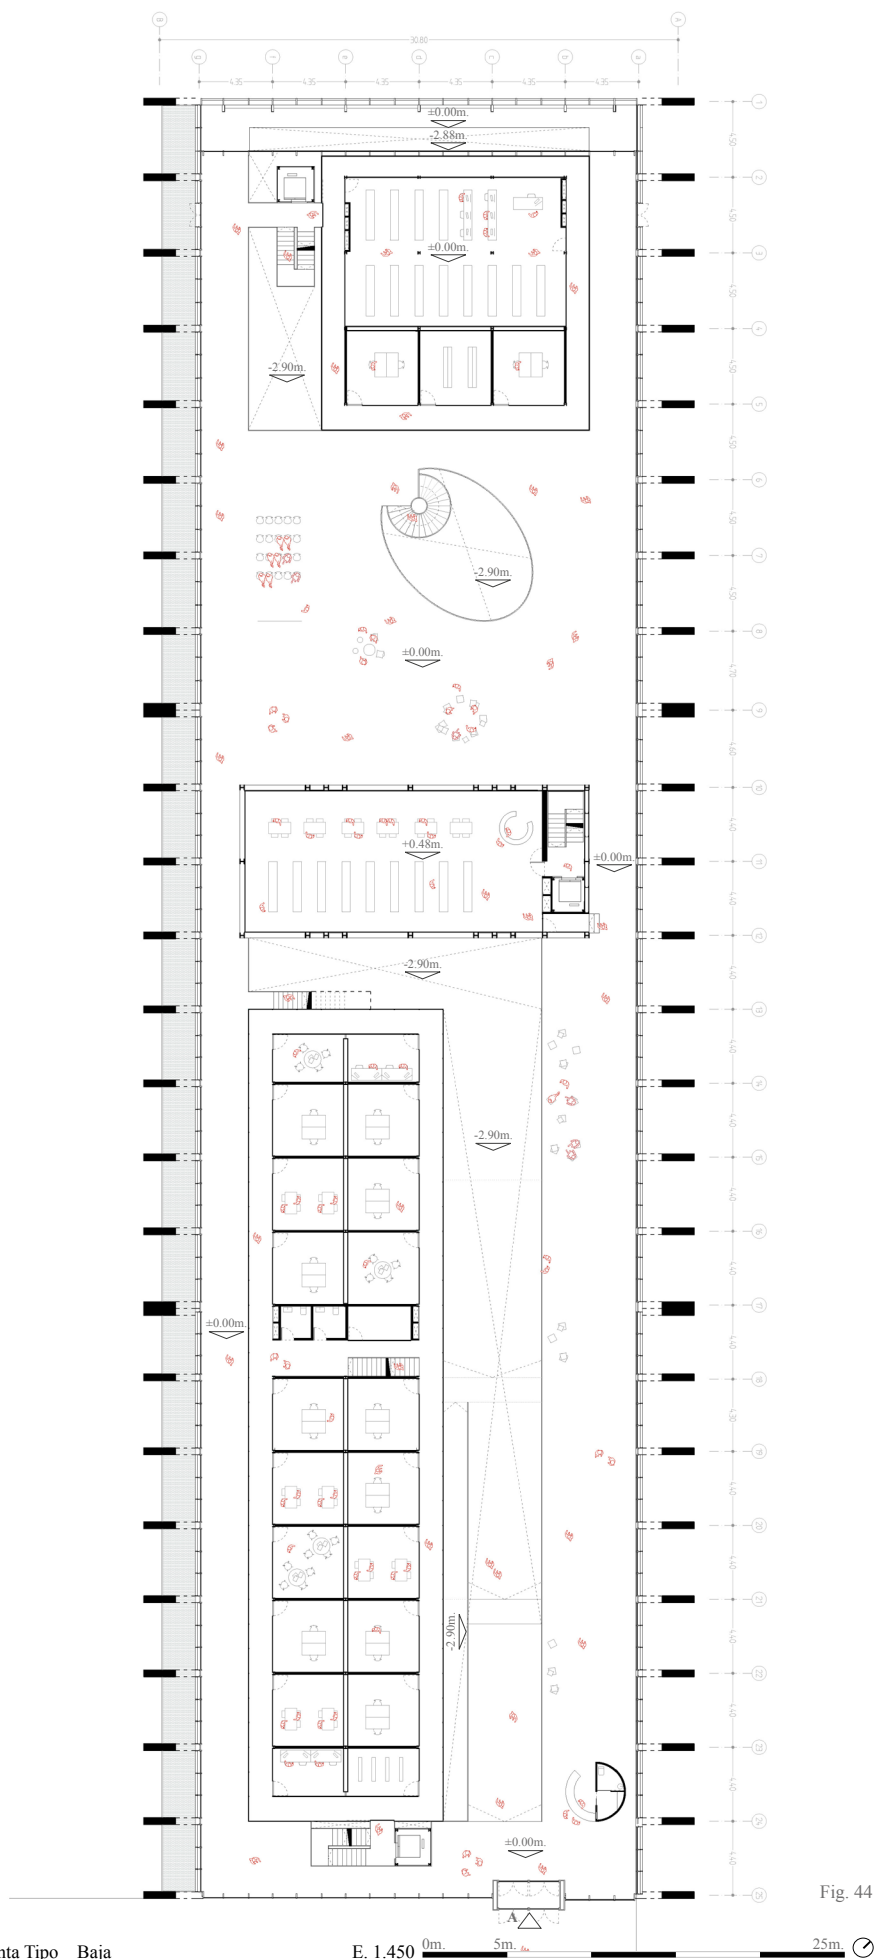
Planta Tipo (nivel representado: P. Baja). Edificio Nave Embarcadero, Nieto & Sobejano Arquitectos, Cáceres, España, 2008 (Fuente: Elaboración propia)
